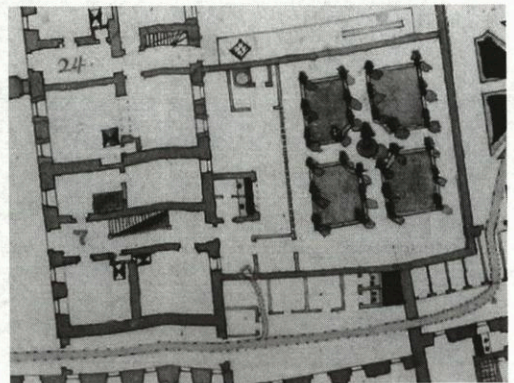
Obermünsterplatz 11, Grundriss vor 1766
